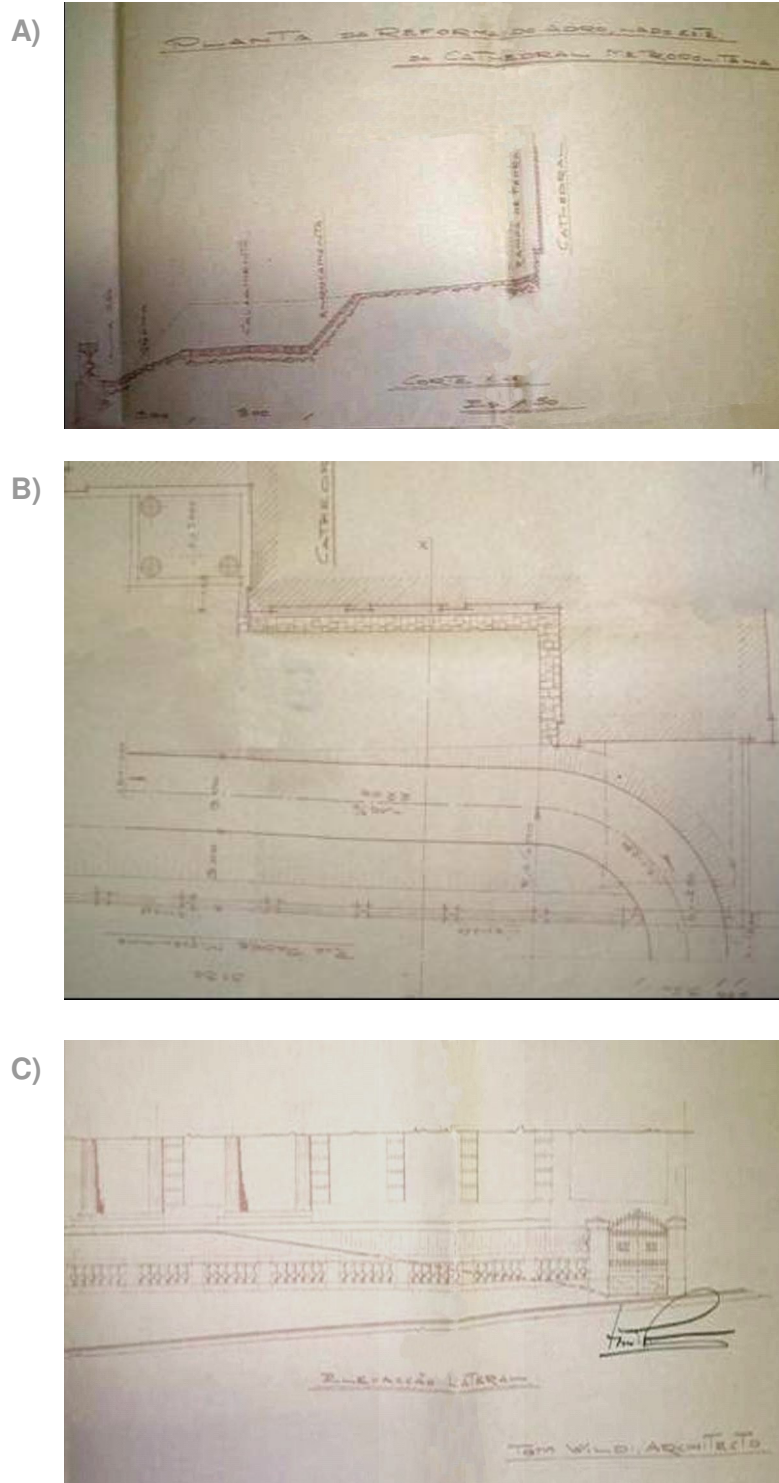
Conjunto de imagens desmembradas do desenho em planta da reforma de 1934.
